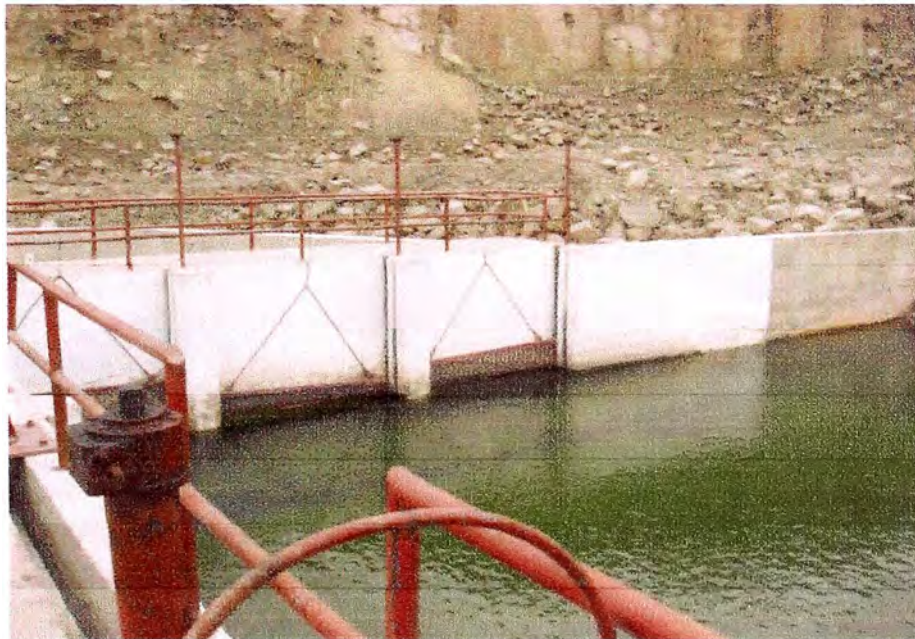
Compuertas Desgravadoras con rejillas metálicas
